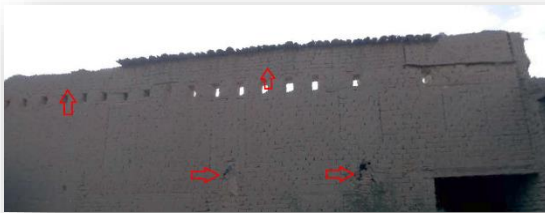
Façade Ouest du caravansérail dont le mur en partie, est protégé par la toiture. Source : Auteure.2022
